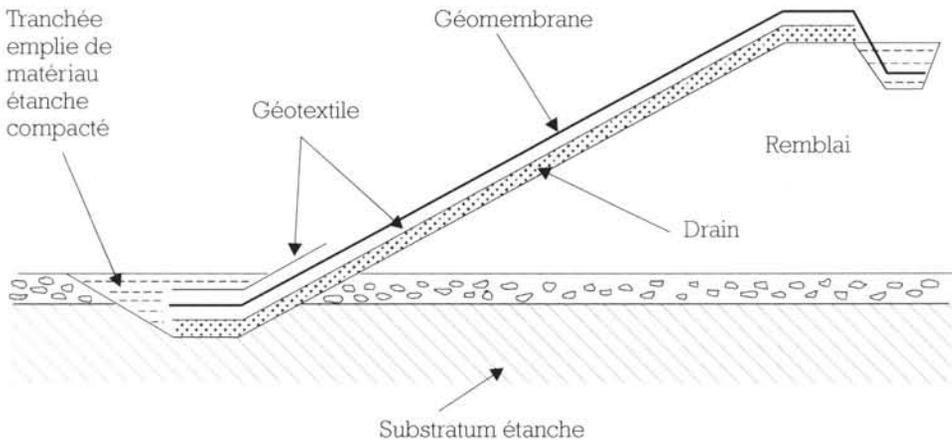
Ancre de pied dans une clé d'étanchéité (d'après « Étanchéité des barrages par géomembranes : technique actuelle » - Bulletin n°78 de la C.I.G.B. - 140 pp -1991 - [56])[56]).
